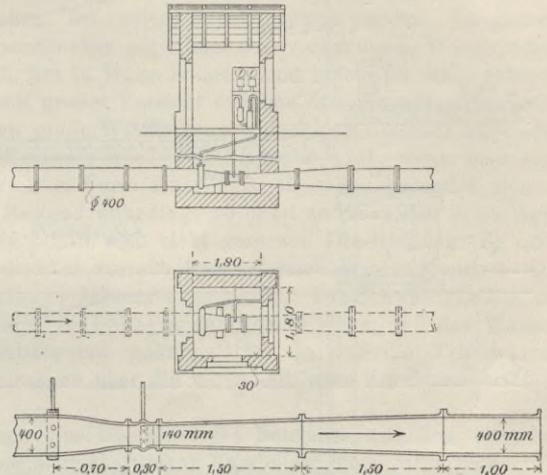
Venturimeter zur Messung der Wasserabgabe mit selbsttätiger Aufzeichnung.
